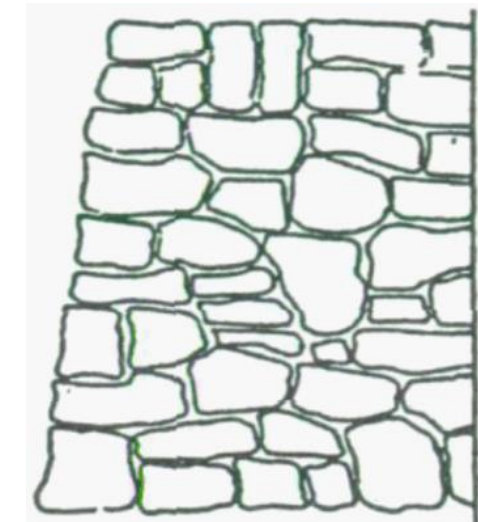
Esquema de muro de mampostería ordinaria tosca. Fuente: Tipología de muros de carreteras.
